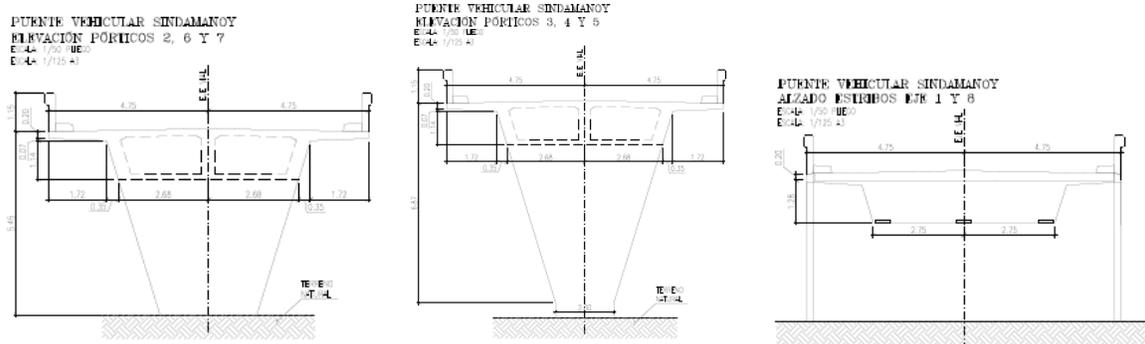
Vista General Puente Sindamanoy estribos y pilas
